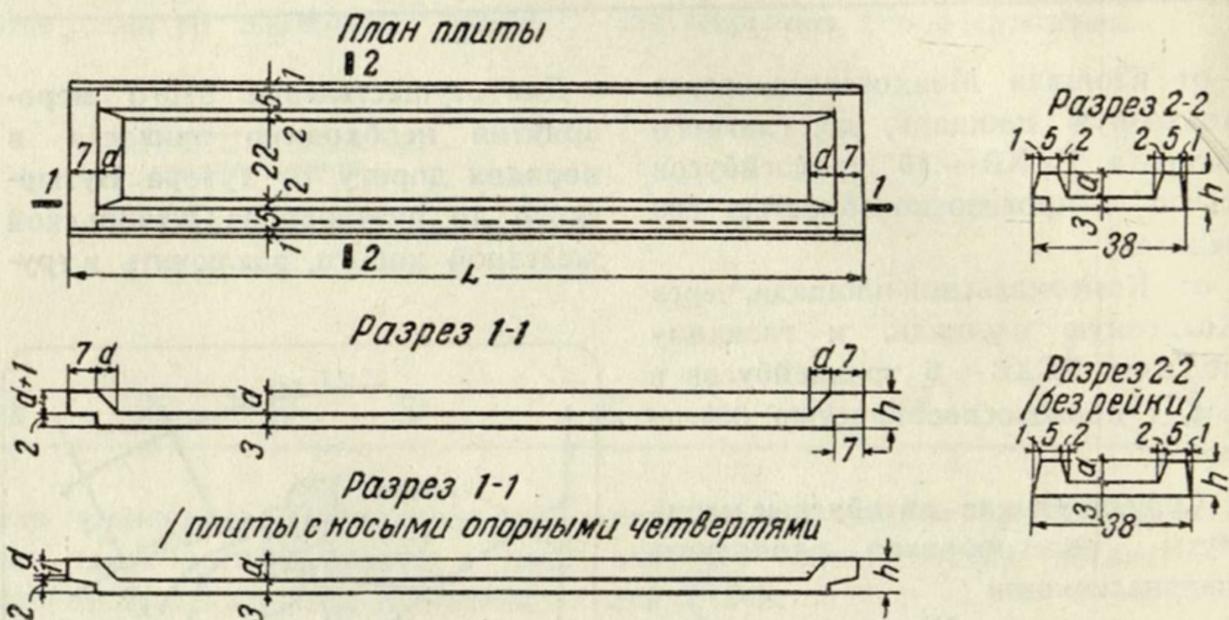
Плиты междуэтажных перекрытий марки «ПМ».
